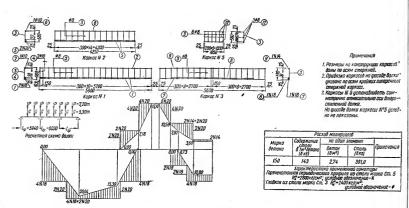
Конструкция главной балки, армированной сварными каркасами.
